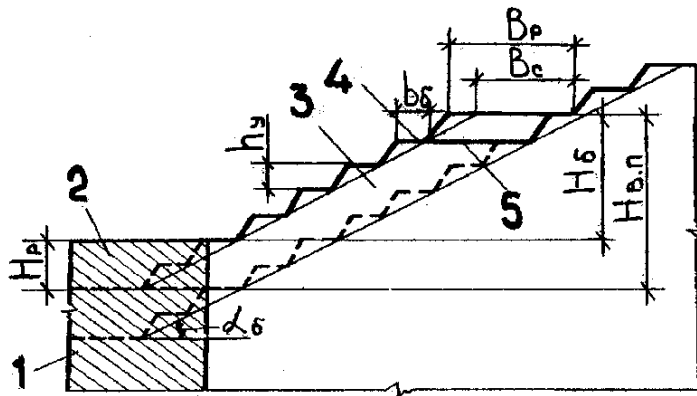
Конструкція робочого борту кар'єра: 1 – поклад корисної копалини; 2 – зона поглиблення; 3 – крутопохилий шар; 4 – тимчасово неробоча площадка; 5 – робоча площадка
